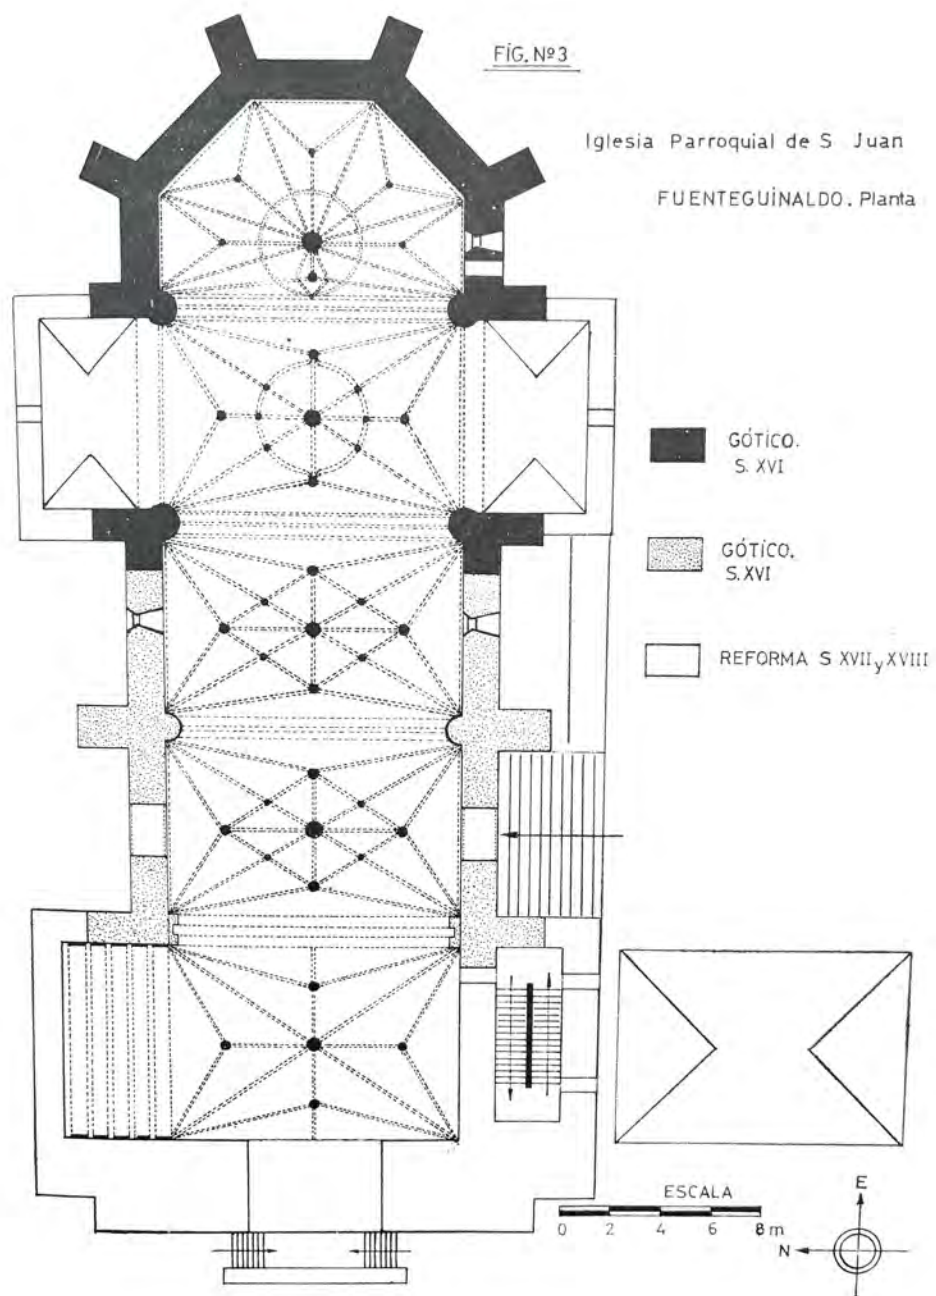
Planta de la iglesia parroquial de Fuenteguinaldo.
